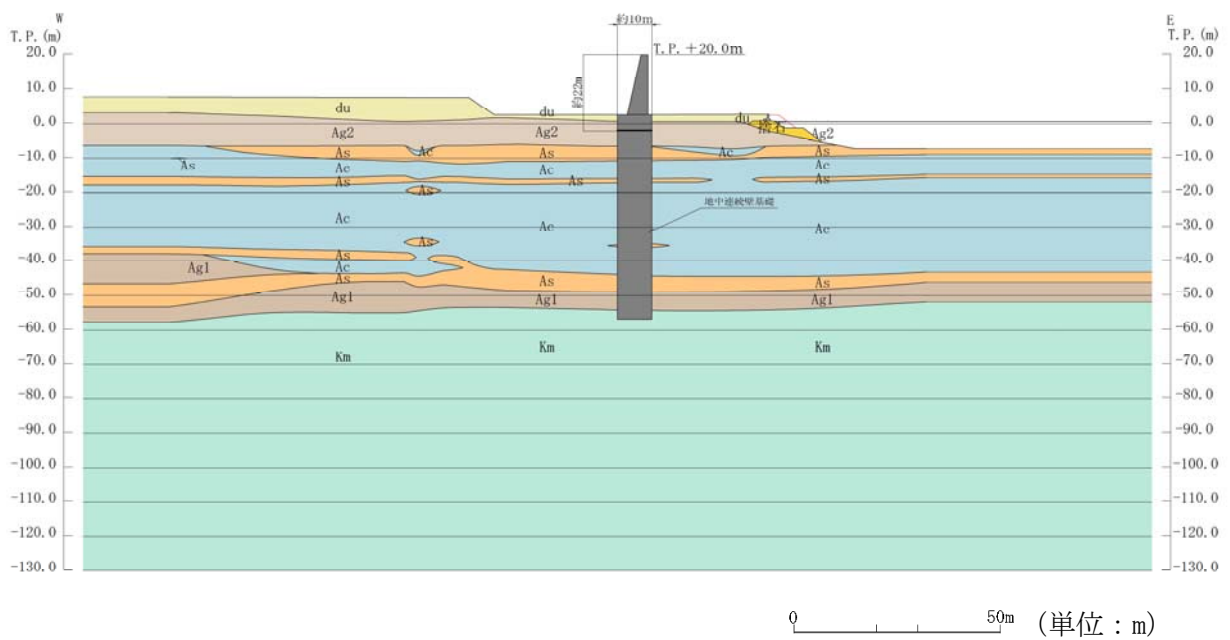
(4) 鉄筋コンクリート防潮壁 評価対象断面図 (④-④断面)
